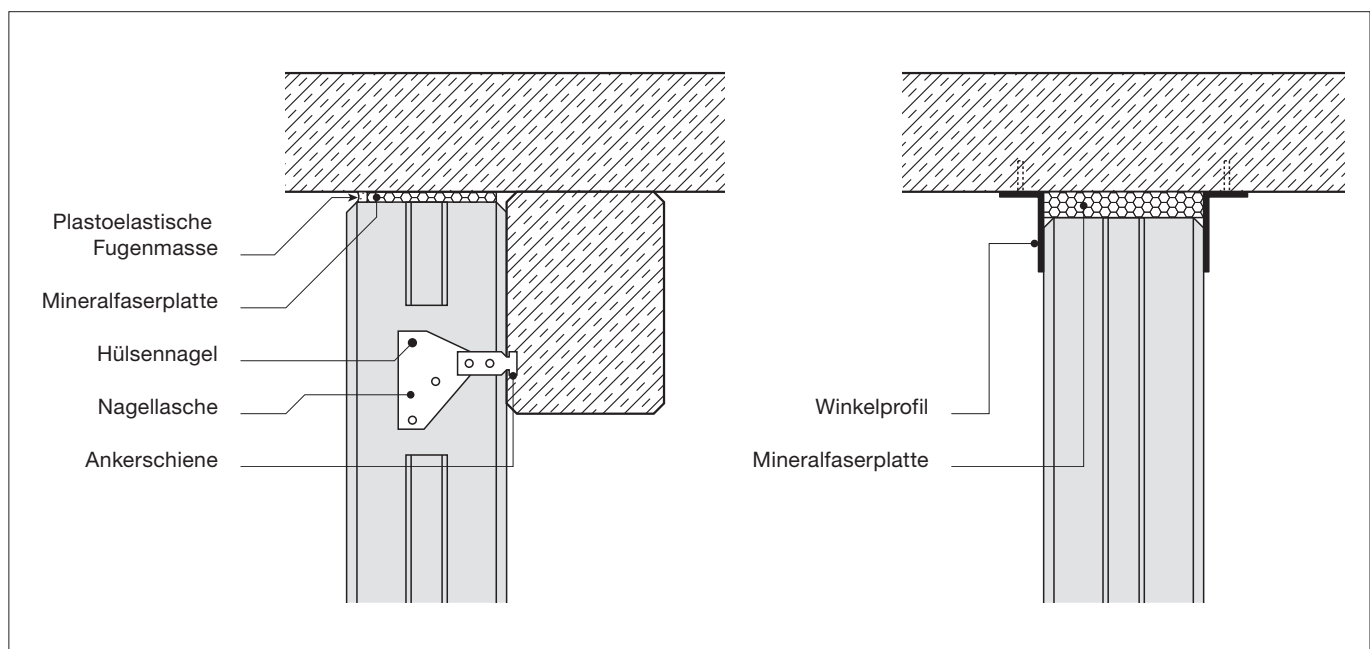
Nachgewiesene, standsichere Kopfanschlüsse bei Brandwänden (Anschluss Wand-Stahlbetonbinder bzw. Stahlbetondecke) bis zu Klasse F 90-A
